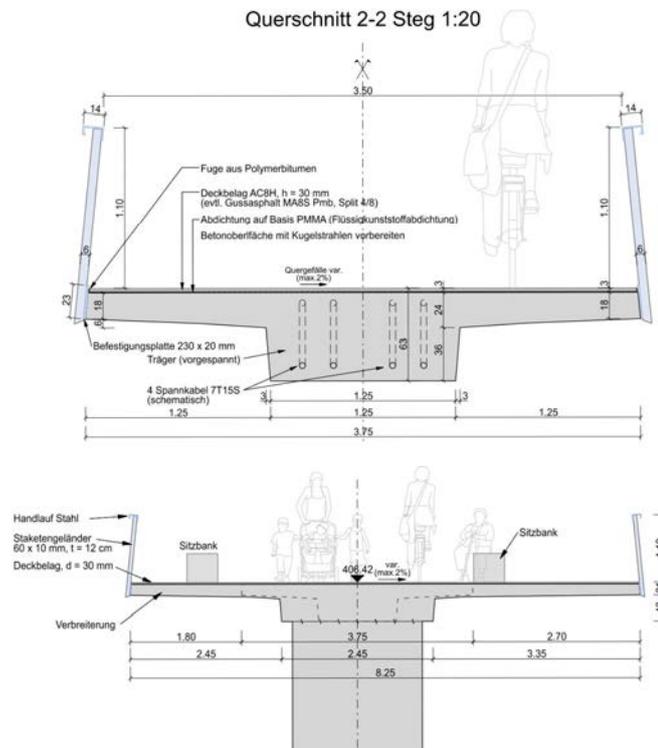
Brückenquerschnitt des Kobelsteigs (oben: normaler Trägerquerschnitt, unten: Trägerquerschnitt mit Kanzeln und Sitzbänken)
